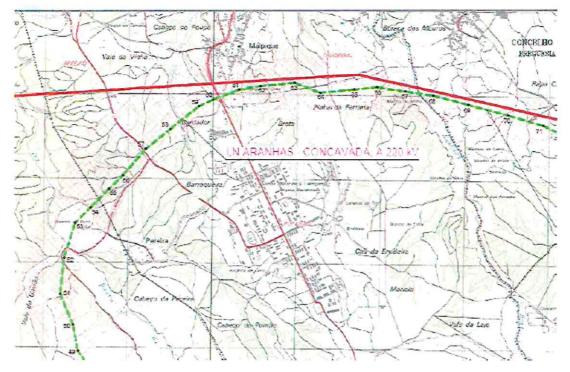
LN ARANHAS - CONCAVADA, A 220 kV - Extrato da Planta Geral do Projeto Prévio
